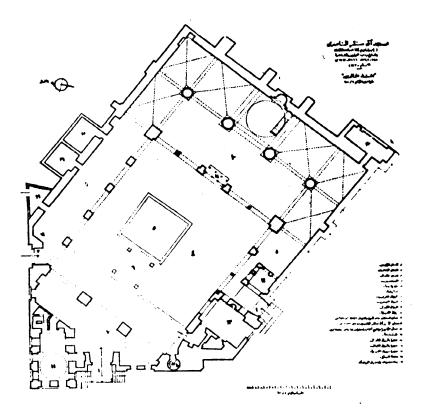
مسقط أفقى لمسجد وقبة الماس الحاجب «عن كلر »
